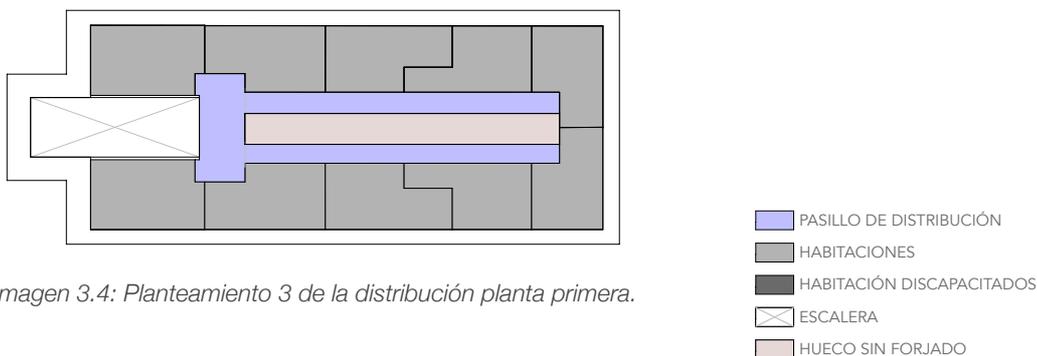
Planteamiento 3 de la distribución planta primera.
